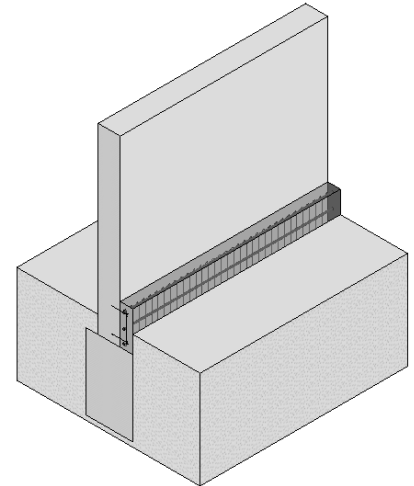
La tipología de acero de refuerzo será definido de acuerdo por el Estructurista. Fuente: Elaboración propia.
